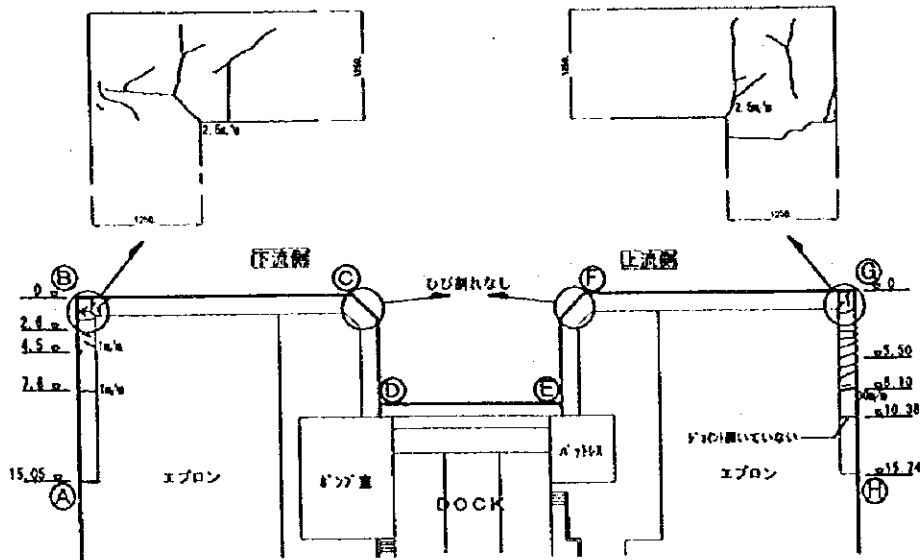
護岸上部コンクリートのひび割れ位置図
